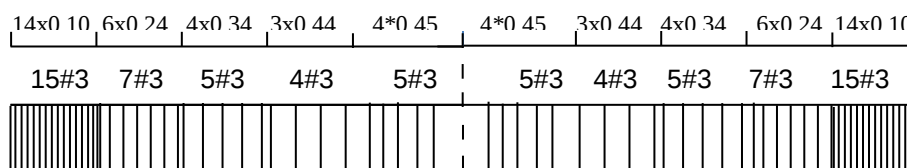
Detalle de colocación de los estribos a lo largo de la viga.
